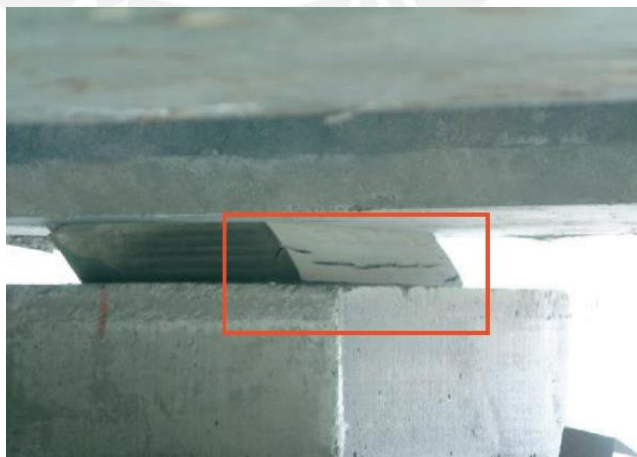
24: Fisuras en el apoyo de neopreno (Ministerio de Fomento, 2009)
